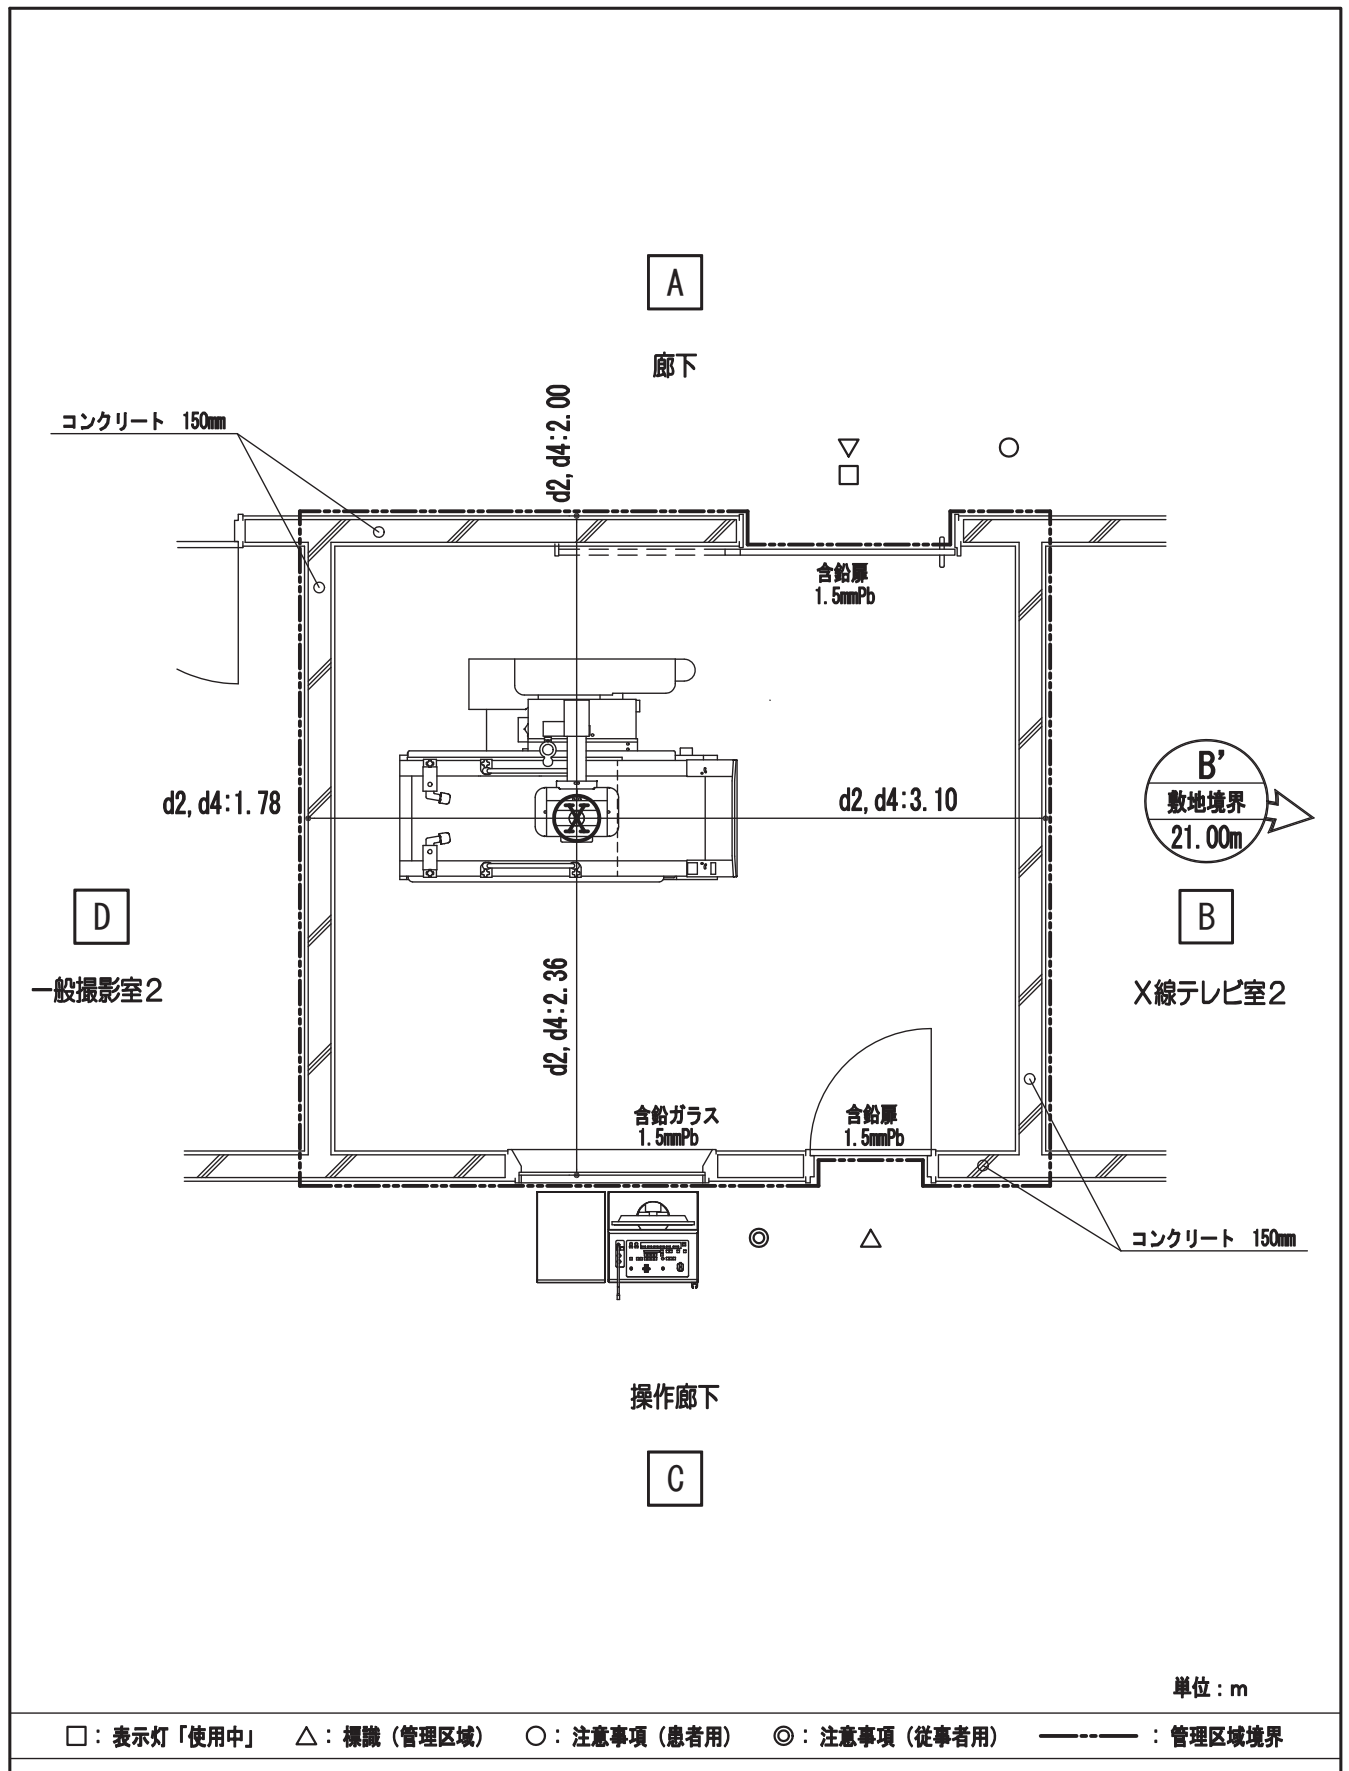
X線テレビ室 臥位 透視・撮影 平面図
